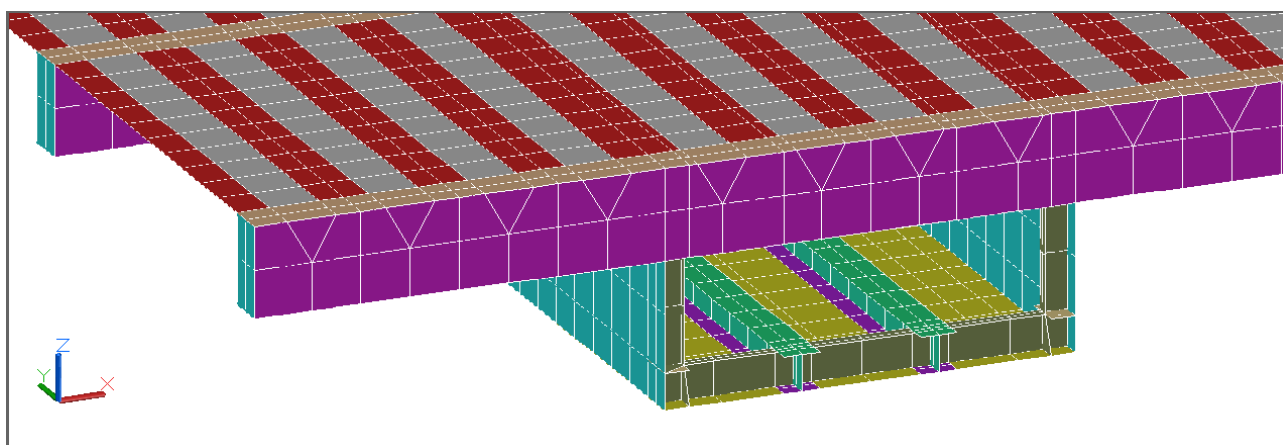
Detalle despiece 3DCARA: ortótropo, viga cajón, perfiles HEB y mamparos
